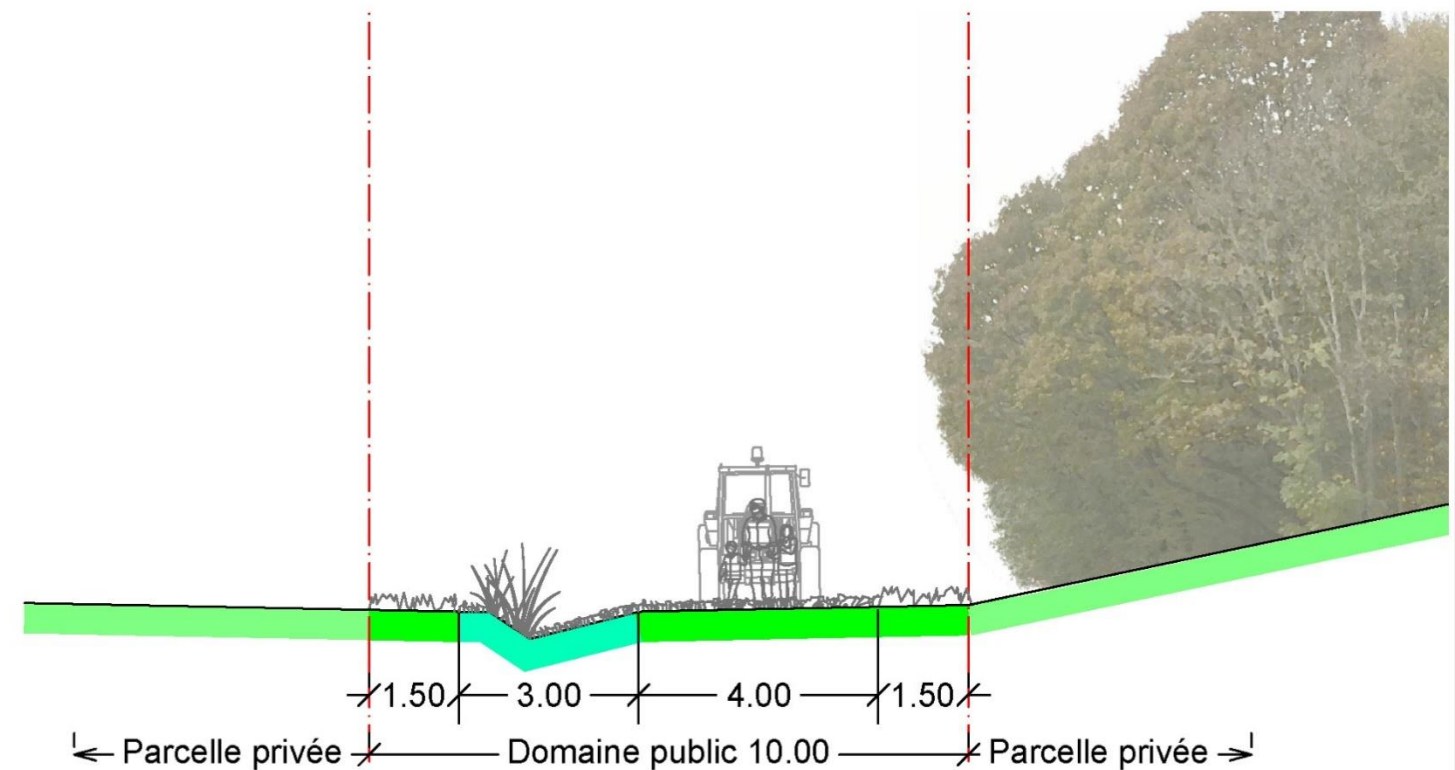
Coupe du rejet des eaux pluviales vers le Bois d'Ingremares
